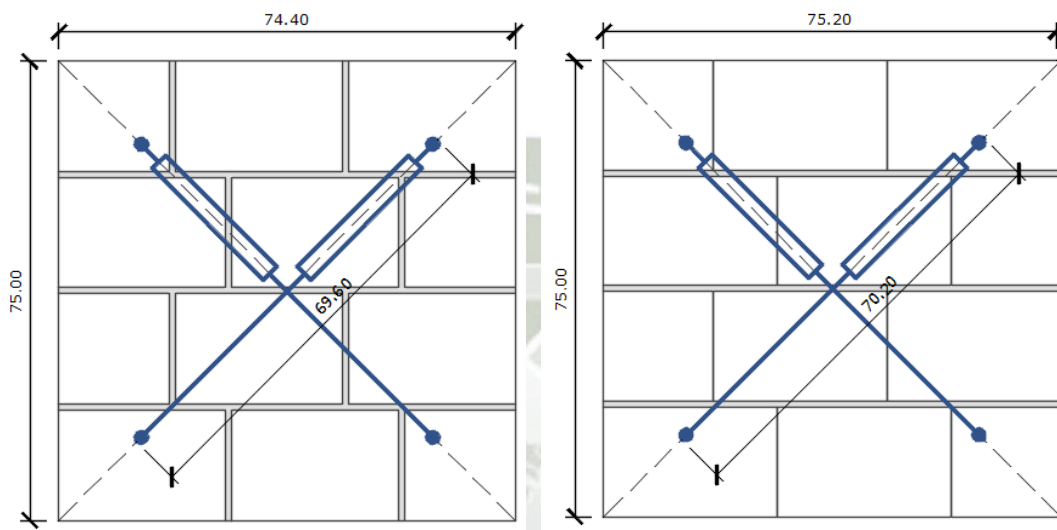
Esquema de murete con junta vertical de mortero (izquierda) y murete con junta vertical machihembrada (derecha).
